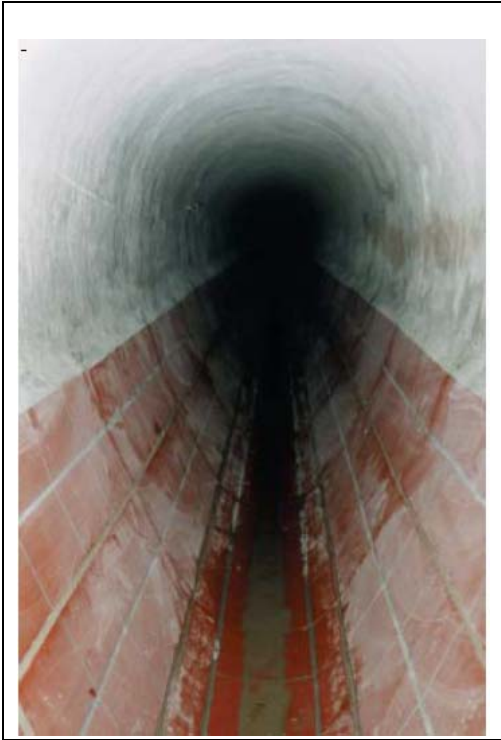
Sanierter Kanal mit Steinzeugplatten
